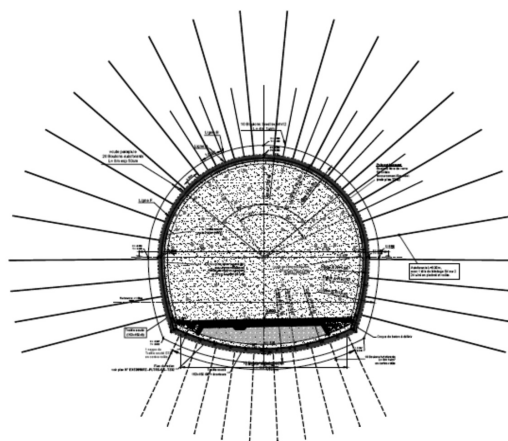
Sezione trasversale del tunnel (P7.3) con il sistema di sostegno del cavo adottato tra le progressive 1267 e 1324 m, dove si sono manifestate forti convergenze ed è stato riprofilato lo scavo. Tunnel cross section (P7.3) showing the excavation-support system adopted between chainage 1267 and 1324 m, where large convergences were experienced and re-profiling was required per Fig. 1.
